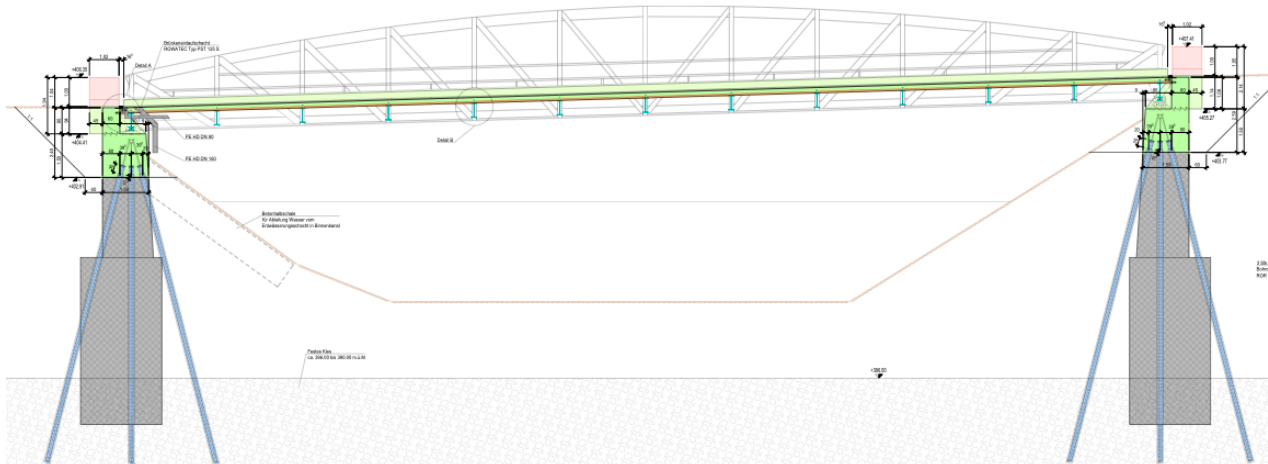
Längsschnitt Brücke mit den Mikropfählen gemäss Bauwerksplan [4]
